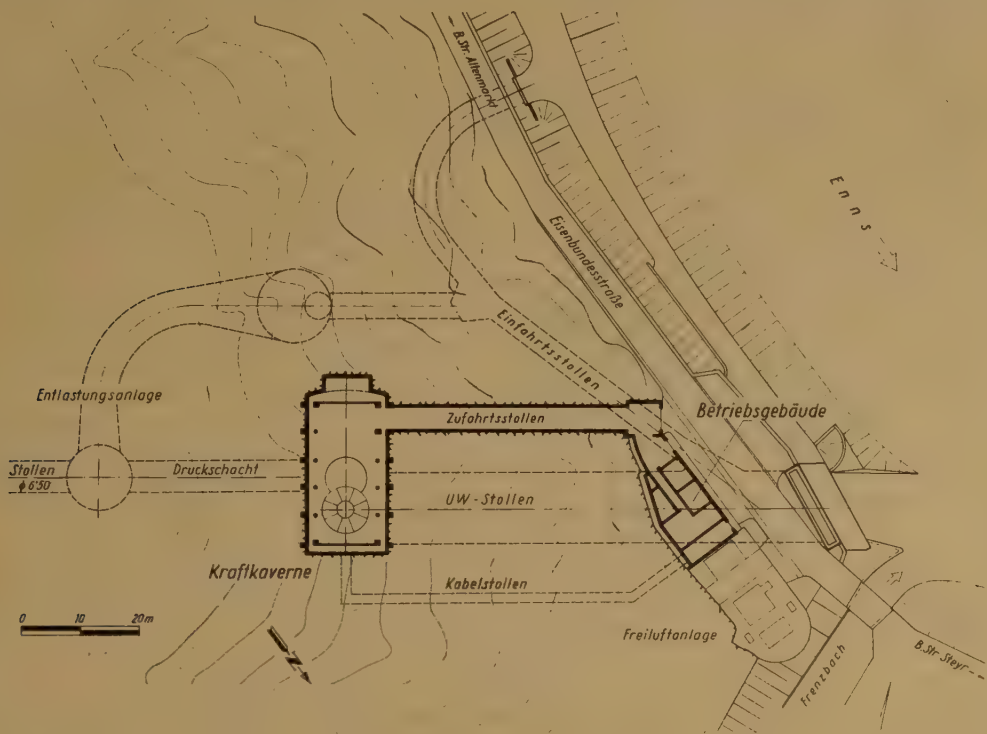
Lageplan der Kaverne und Entlastungsanlage
